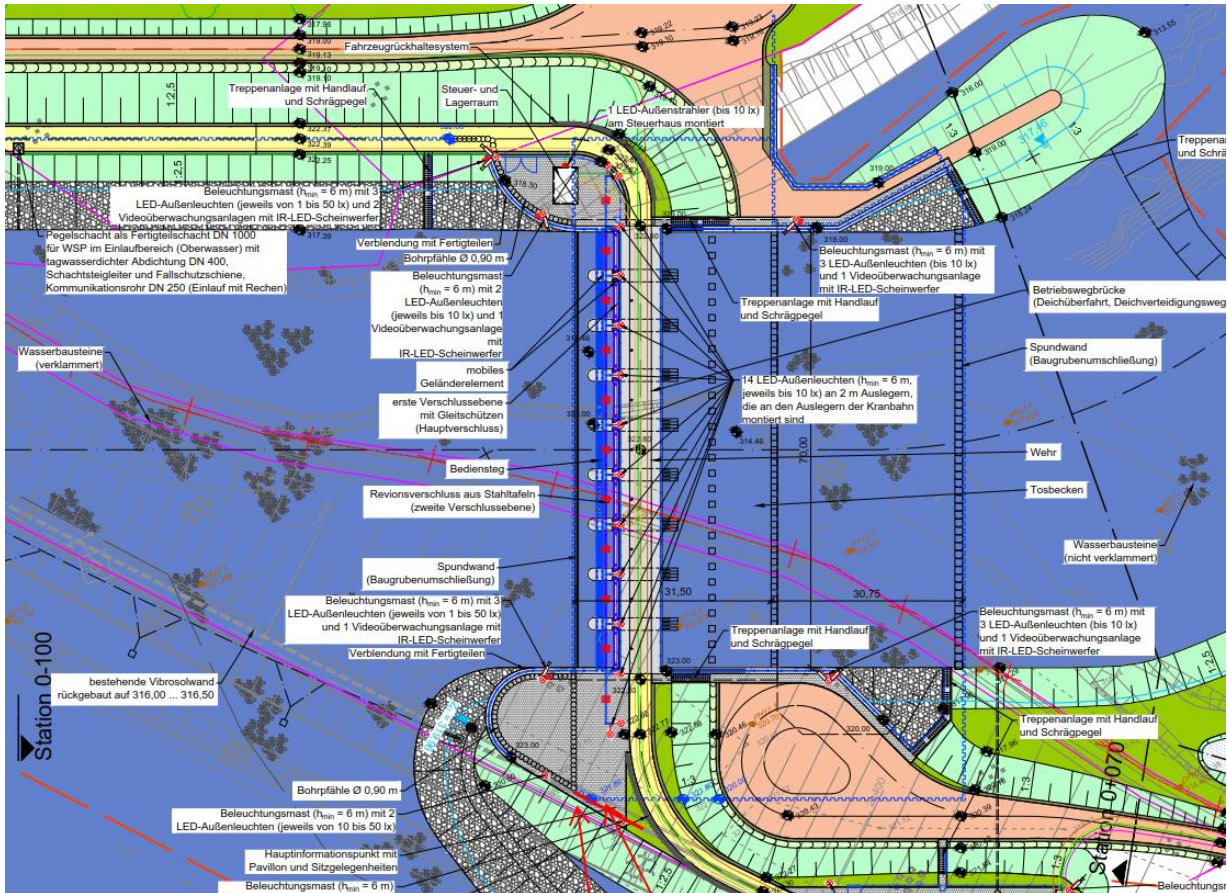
Einlaufbauwerk, Ausschnitt Detaillageplan (aus Plan 04-01-01)
